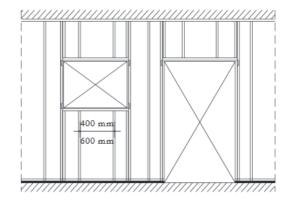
Detalle estructura portante de acero. Fuente: ATEDY
